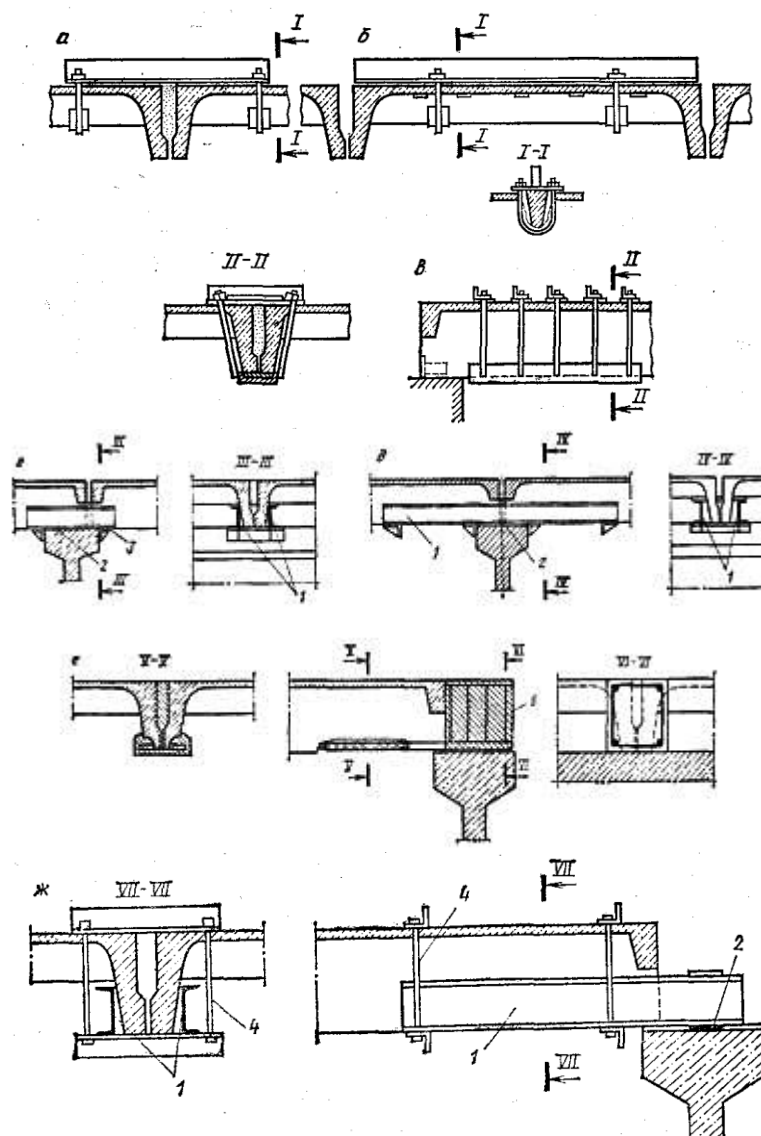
Усиление конструкций (а – опорных частей ребристых плит с помощью балки; б – подвеска плит; в – хомутами; г – увеличение площади опирания плит на прогоны; д – усиление ребер несущих панелей (балок–стенок); е, ж – увеличение площади опирания плит на торцевые балки; 1 – стальные балки; 2 – центрирующие подкладки; 3 – место подклинки; 4 – болты; 5 – каркас, связанный с арматурой панели
